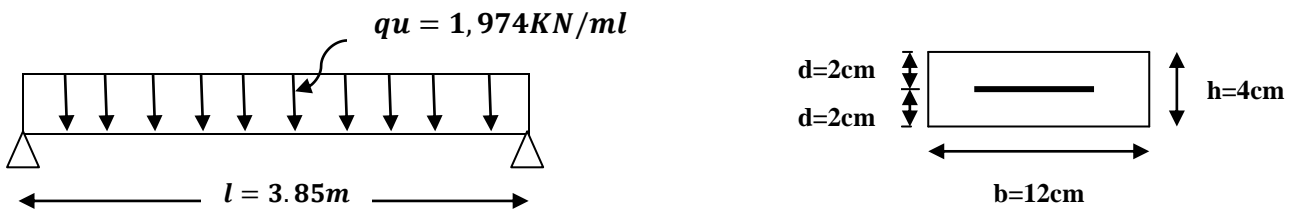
Schéma statique de calcul de la poutrelle.
